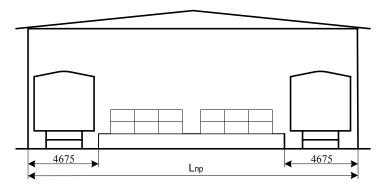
Поперечный разрез грузосортировочной площадки
